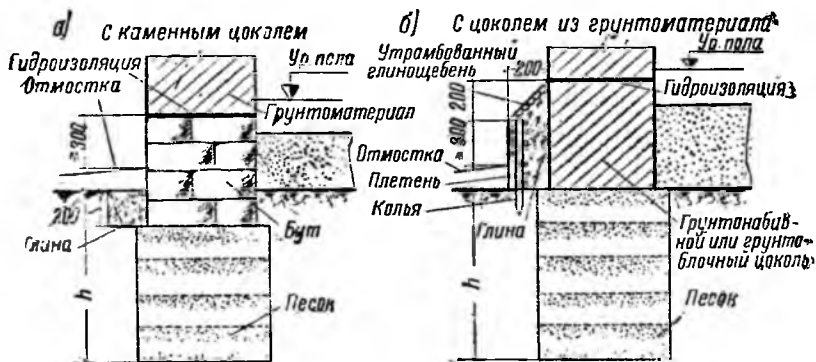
Фундаменты под грунтоблочные и грунтонабивные стены
